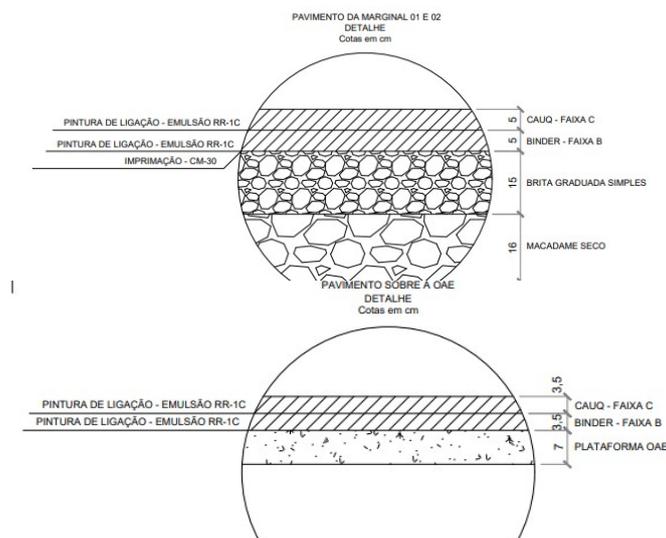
Projeto Pavimentação (Anteprojeto “Trevo Catuai”, 2021).
